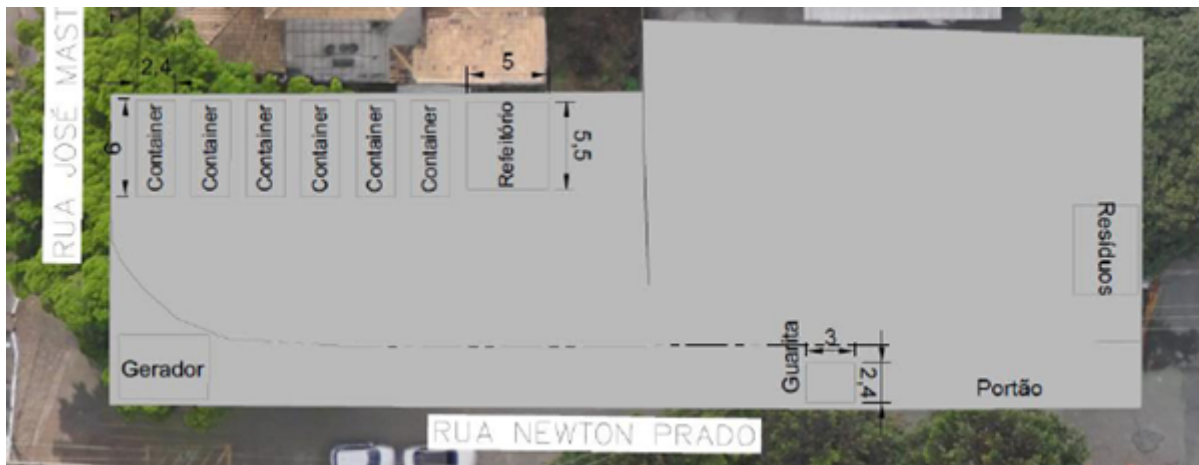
Layout do canteiro de obras – ponte/estoque vigas
